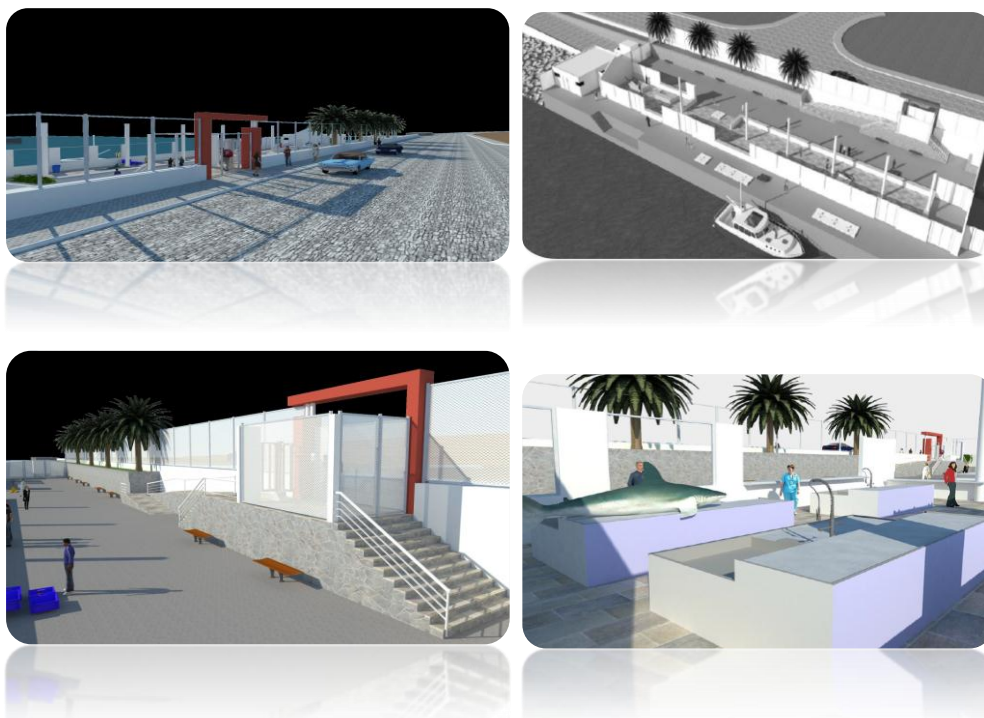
Ilustração das futuras instalações para um sistema de lota.
